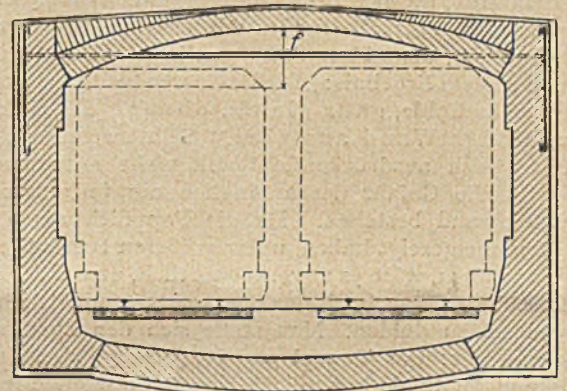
a. Vorgeschlagener Querschnitt für normale Tunnelstrecken (mit unvollständiger Bewehrung).
